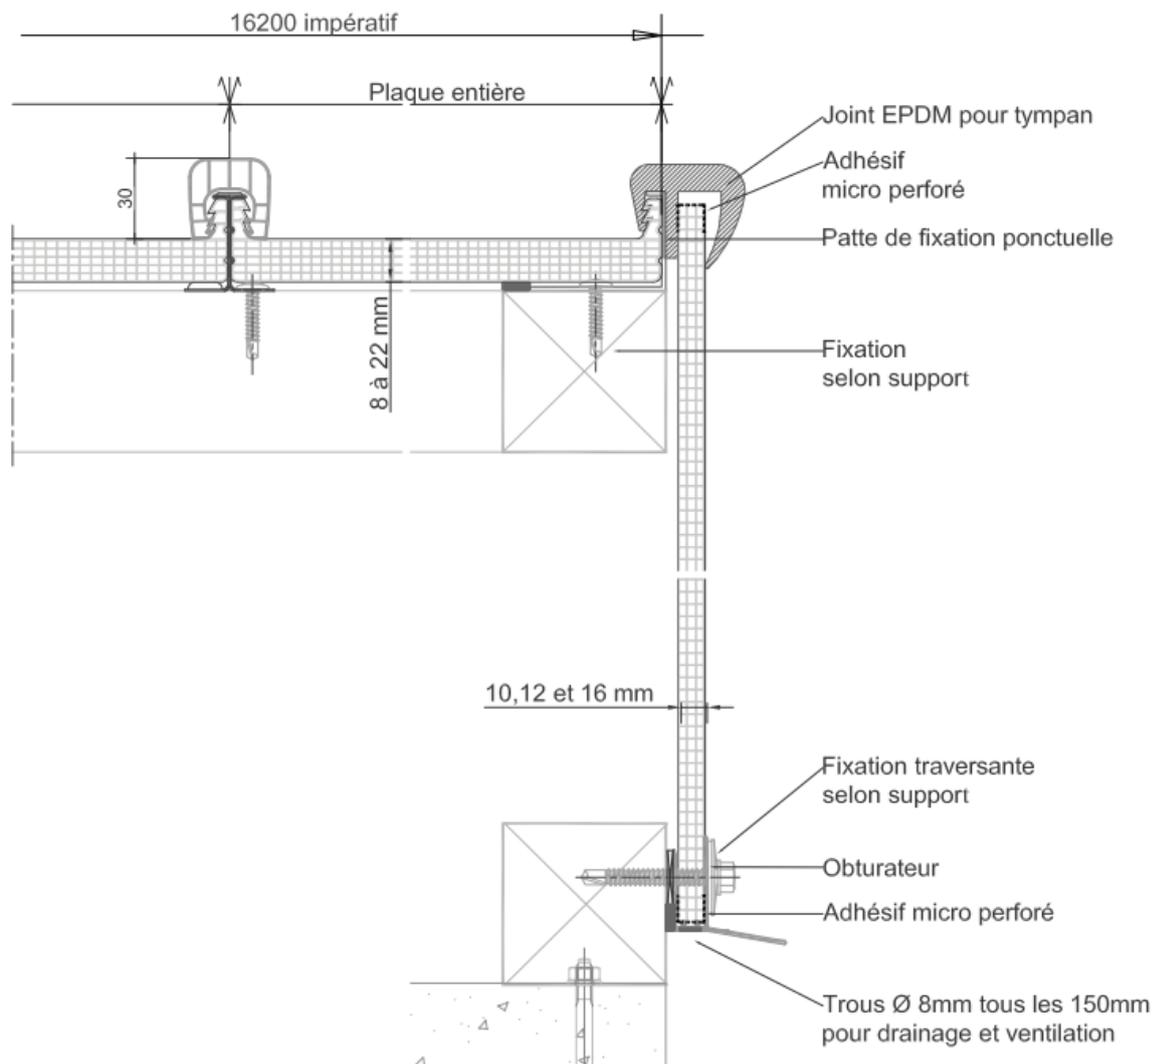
Rive sur tympan – Système DANPAVOUTE
